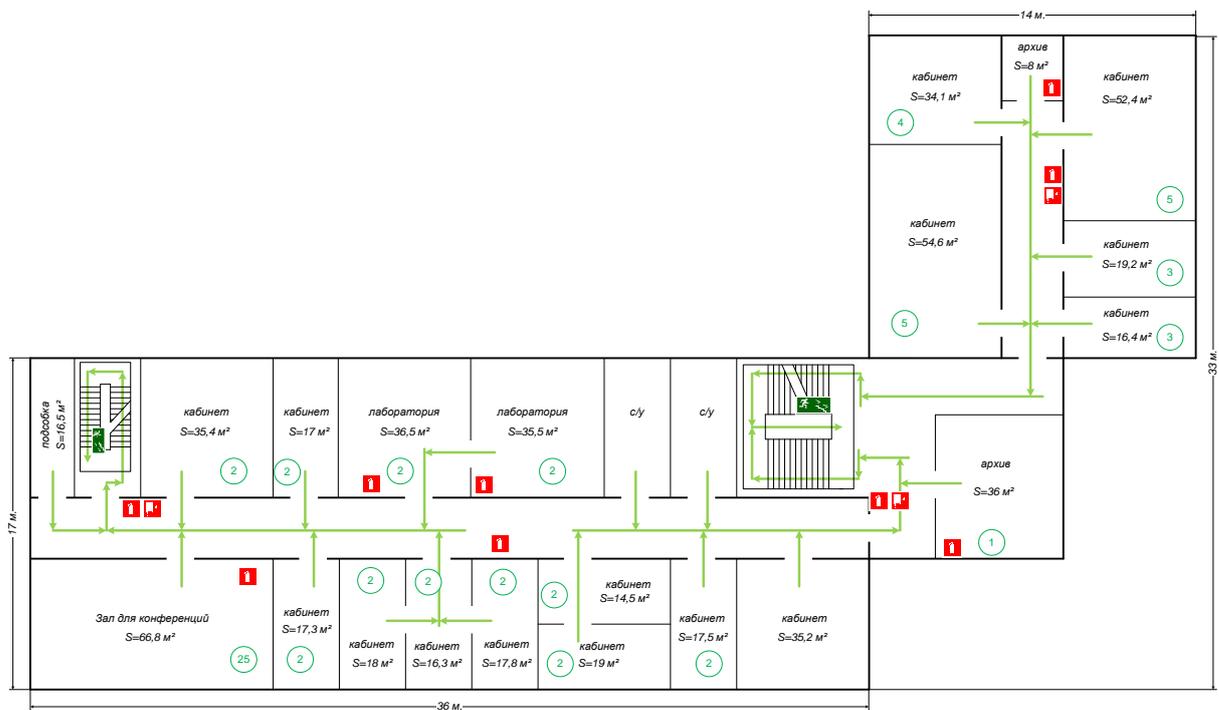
Схема эвакуации из помещений 4-го этажа
